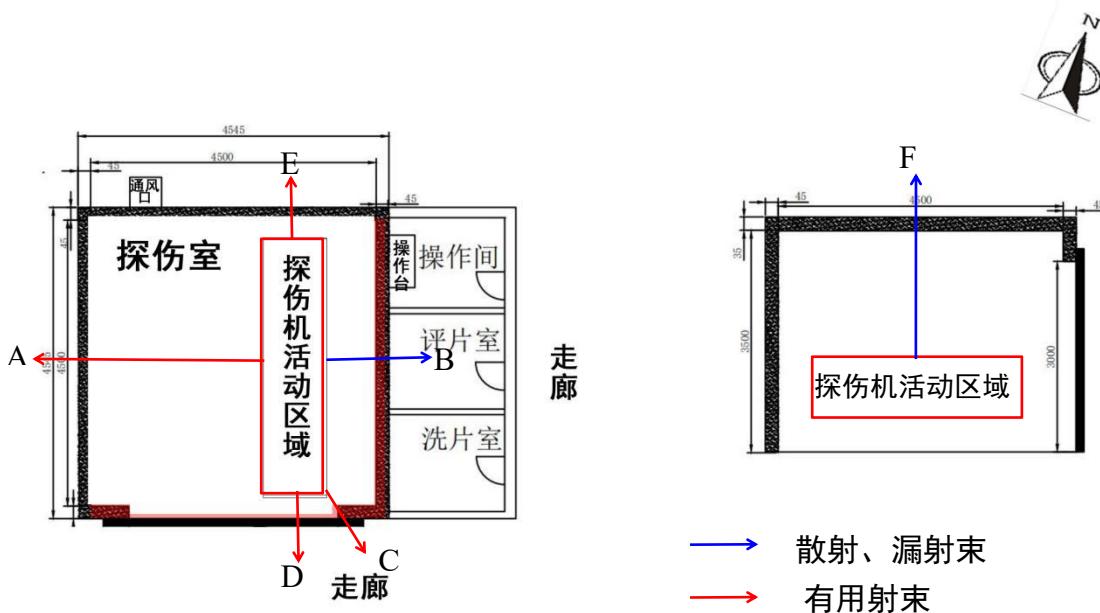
辐射影响核算关注点及辐射路径示意图（平面图以及剖面图）
